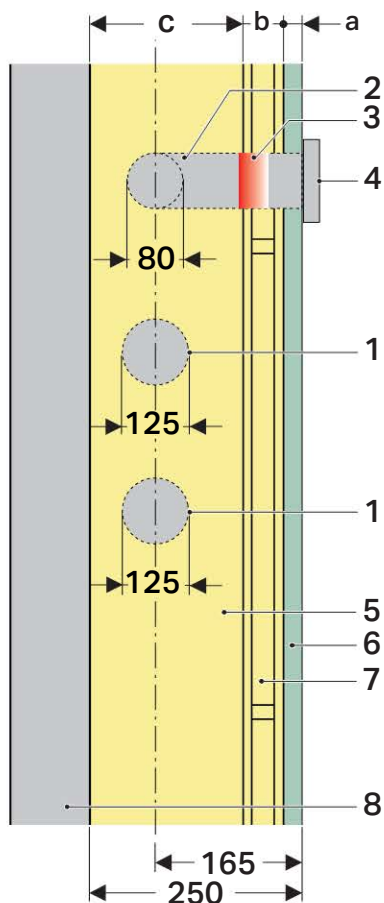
Grundrissdarstellung (Masse in mm)
